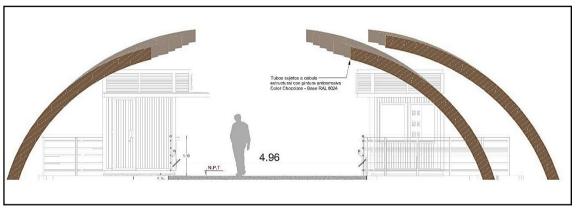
Detalle de ancho mínimo en proyecto Km 14.2 de Vía a la costa
